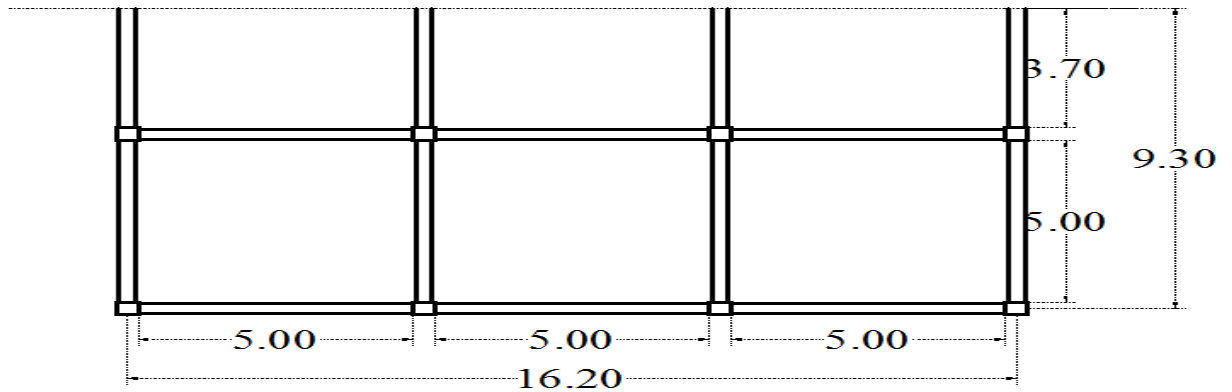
Denah Balok Lantai 1a, 2a, 3a, 4a, 5, 6, 7 yang Menerima Beban Mati Tambahan.
